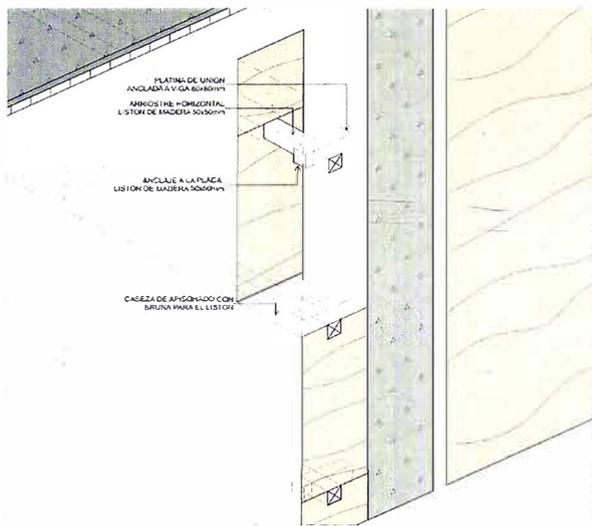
Isometría empalme de tapial al muro de concreto.
